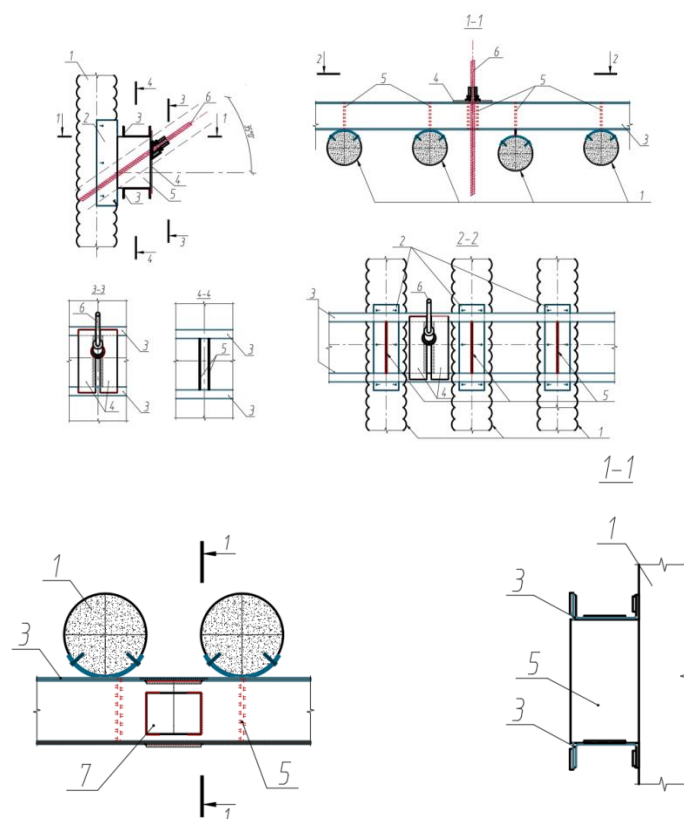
Схема узла крепления грунтовых анкеров к обвязочному поясу:
